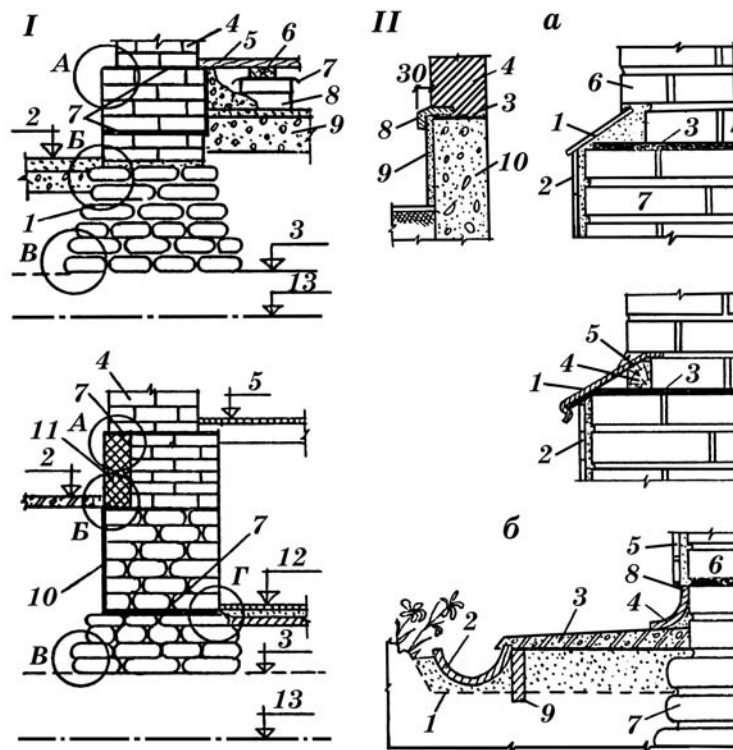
Гидроизоляция для домов из кирпича, бетона и бутобетонных каменных блоков. I. 1 – уступ; 2 – отмостка; 3 – подошва фундамента; 4 – стена; 5 – пол; 6 – балка; 7 – гидроизоляция (толь, рубероид); 8 – столбик; 9 – основание подполья; 10 – двойная обмазка горячим битумом; 11 – облицовка цоколя; 12 – пол подполья; 13 – уровень грунтовых вод; А, Б, В, Г – узлы, требующие тщательной заделки швов и пазов.
